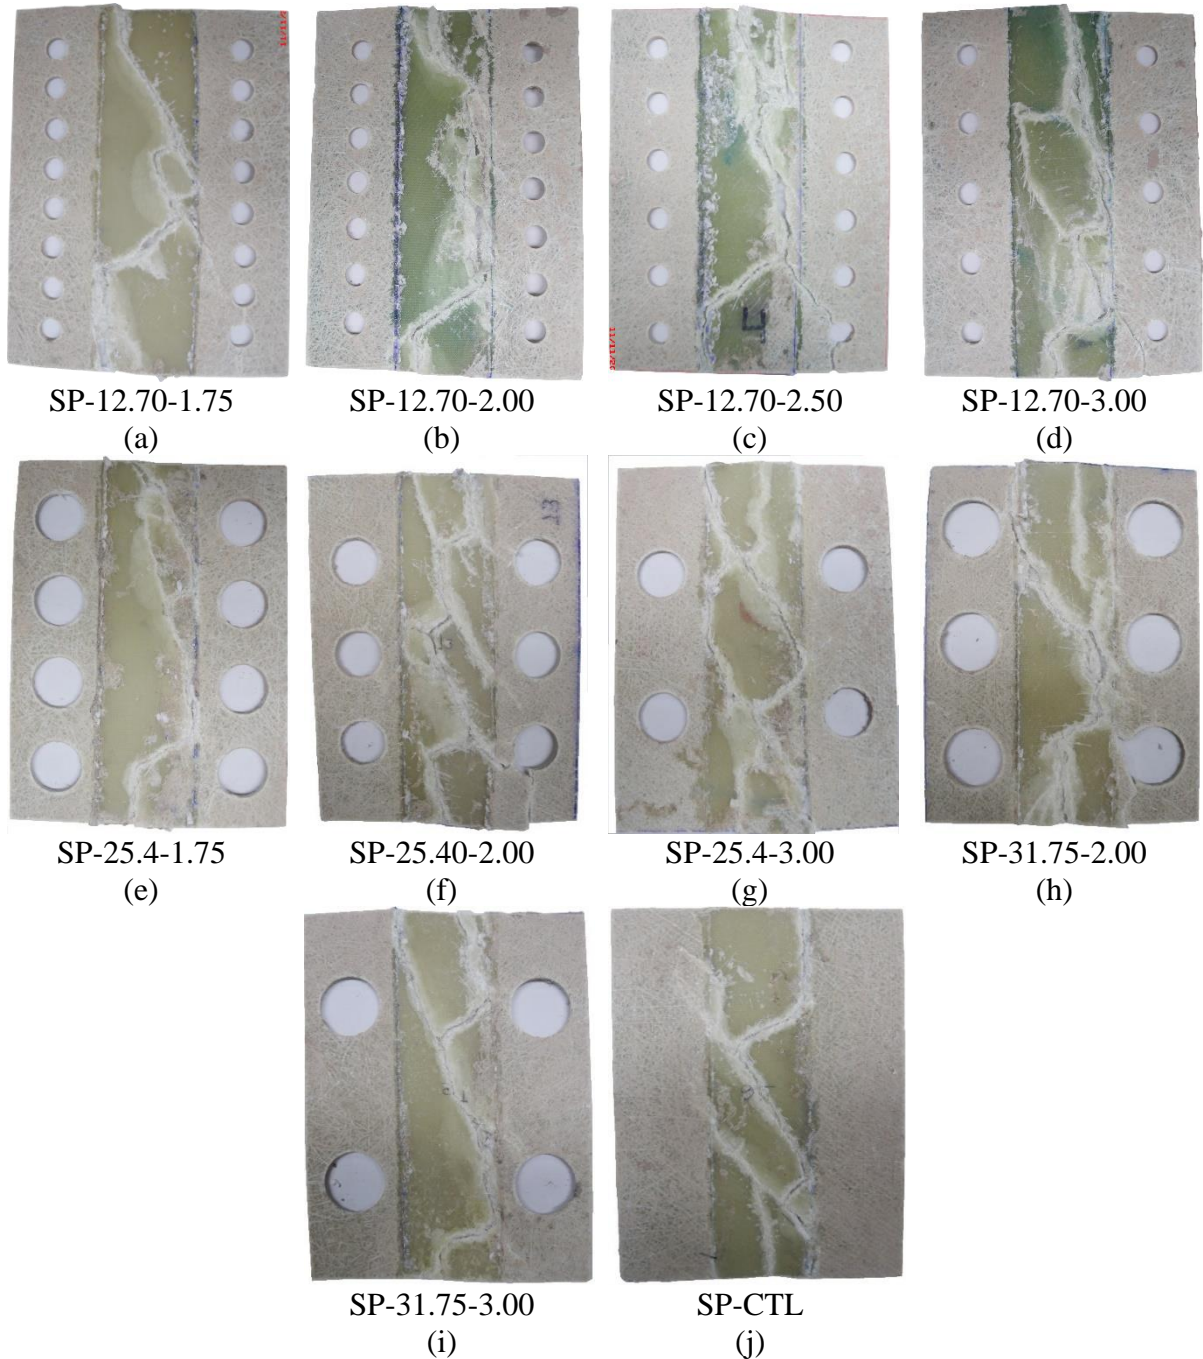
Padrões de fissuração ao final do ensaio, que foram apresentados pelos conectores: (a) SP-12.70-1.75; (b) SP-12.70-2.00; (c) SP-12.70-2.50; (d) SP-12.70-3.00; (e) SP-25.4-1.75; (f) SP-25.40-2.00; (g) SP-25.4-3.00; (h) SP-31.75-2.00; (i) SP-31.75-3.00; (j) SP-CTL.
